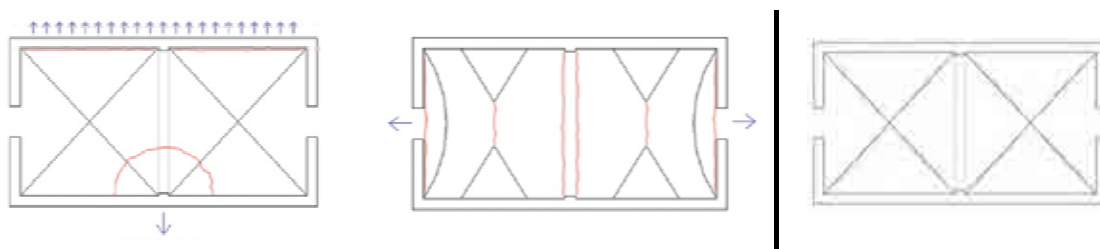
Mecanismos de colapso: M12 y M13 (Ficha modelo B-DP)
